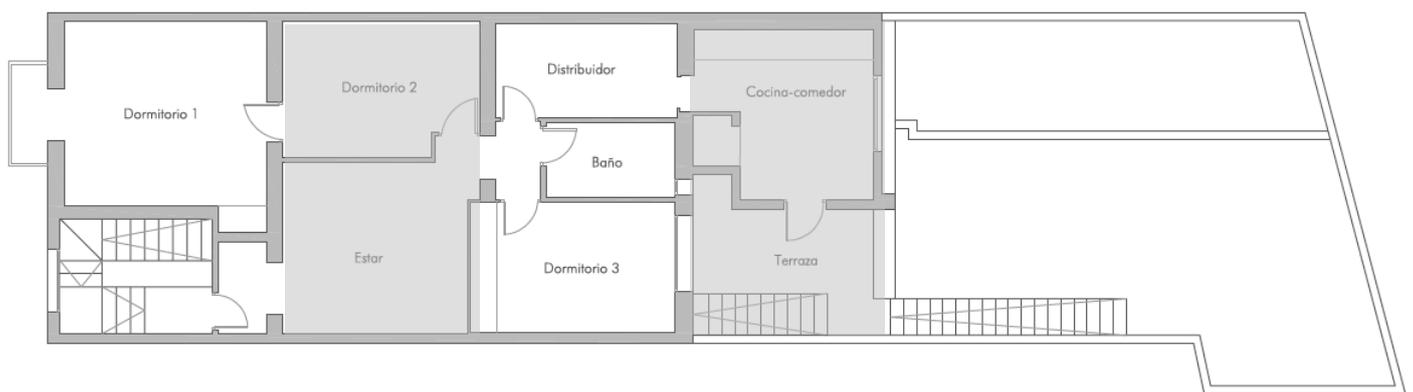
Plano distribución de la vivienda de la planta superior. Fuente: Informe Técnico de José Manuel Mena Toledo (Arquitecto)
